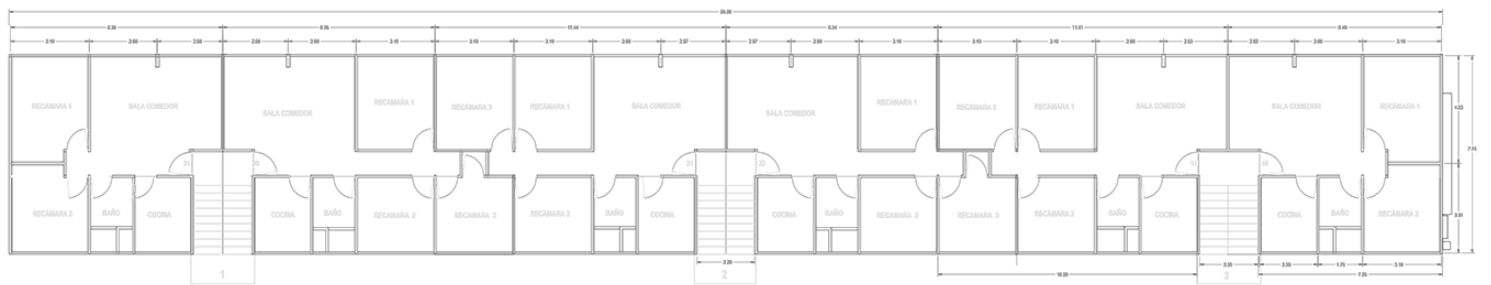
Planta edificio 4B .obras.cdmx.gob.mx
